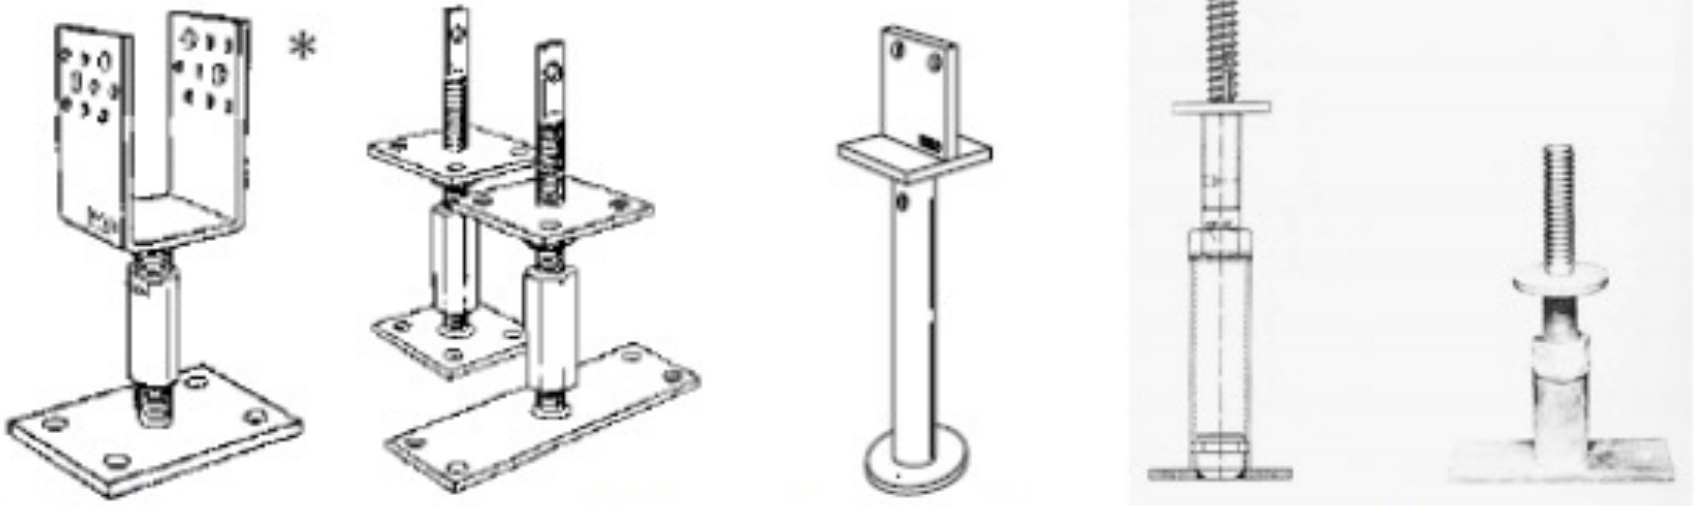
Algunos tipos de bases regulables para pilares de madera: se apoyan sobre placas de montaje o se hormigonan directamente. Los tres primeros marca Bilo, los últimos dos son Top-Foot.
